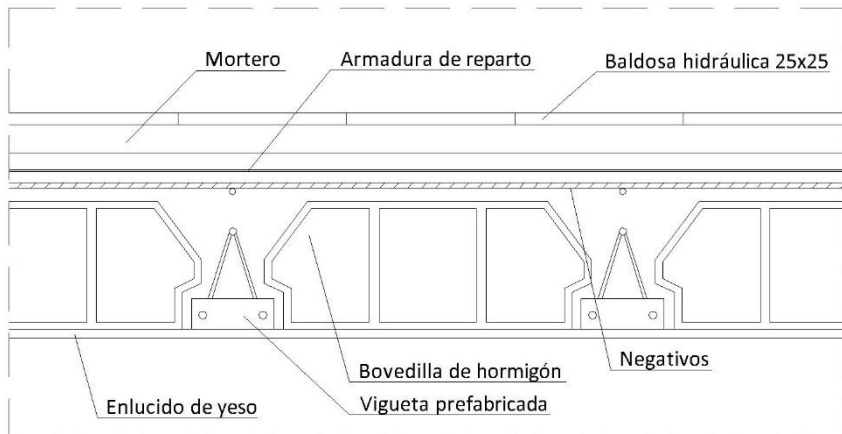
Forjado de viguetas prefabricadas. 2015. Fuente propia.
